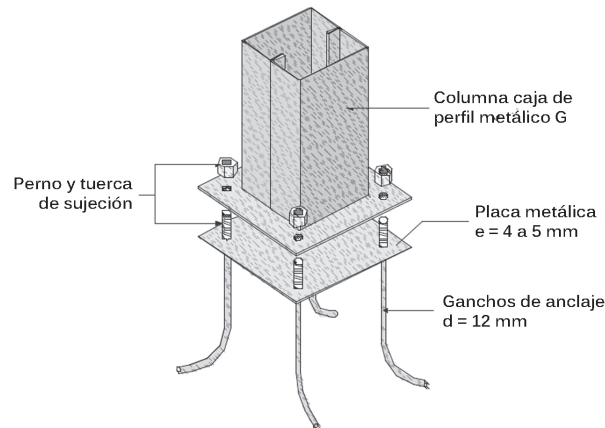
Detalle del empotramiento de una columna metálica y la base de la cimentación mediante pernos
